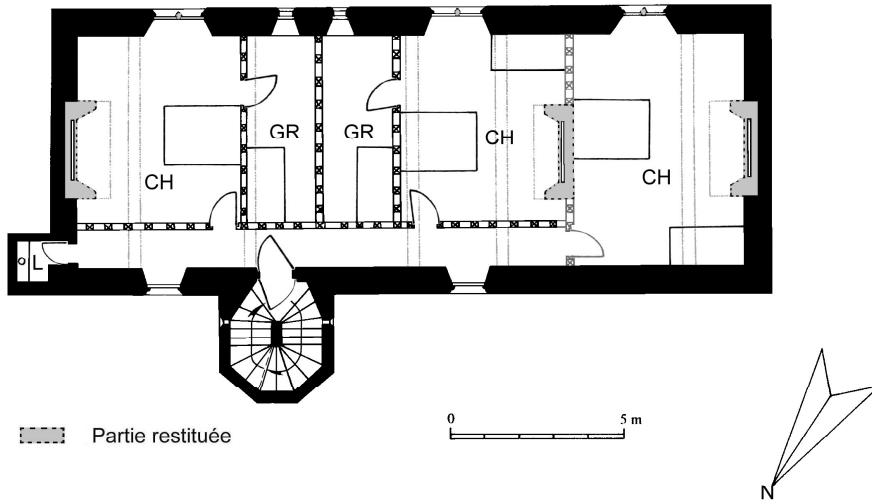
Les Rocques. Plan restitué du premier étage entre 1522 et 1532.
